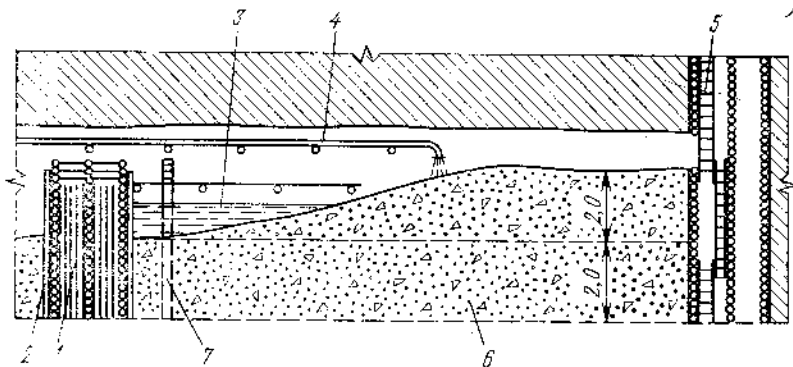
Схема гидрозакладки горизонтального слоя и дренажа воды из «прудка»:
